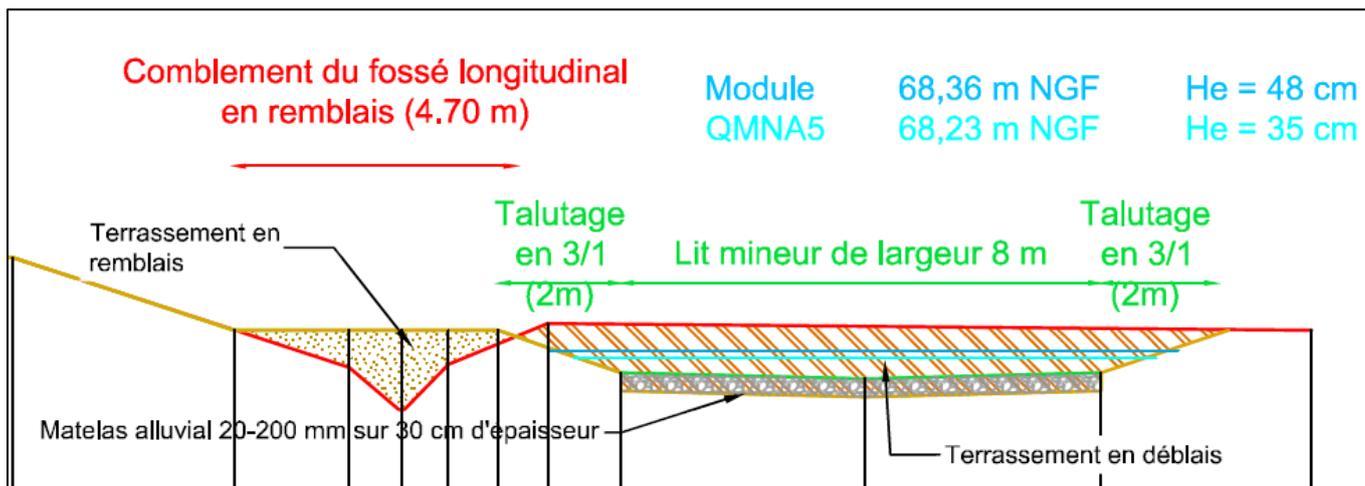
Profil en travers type au droit d'un plat courant (PT8)
